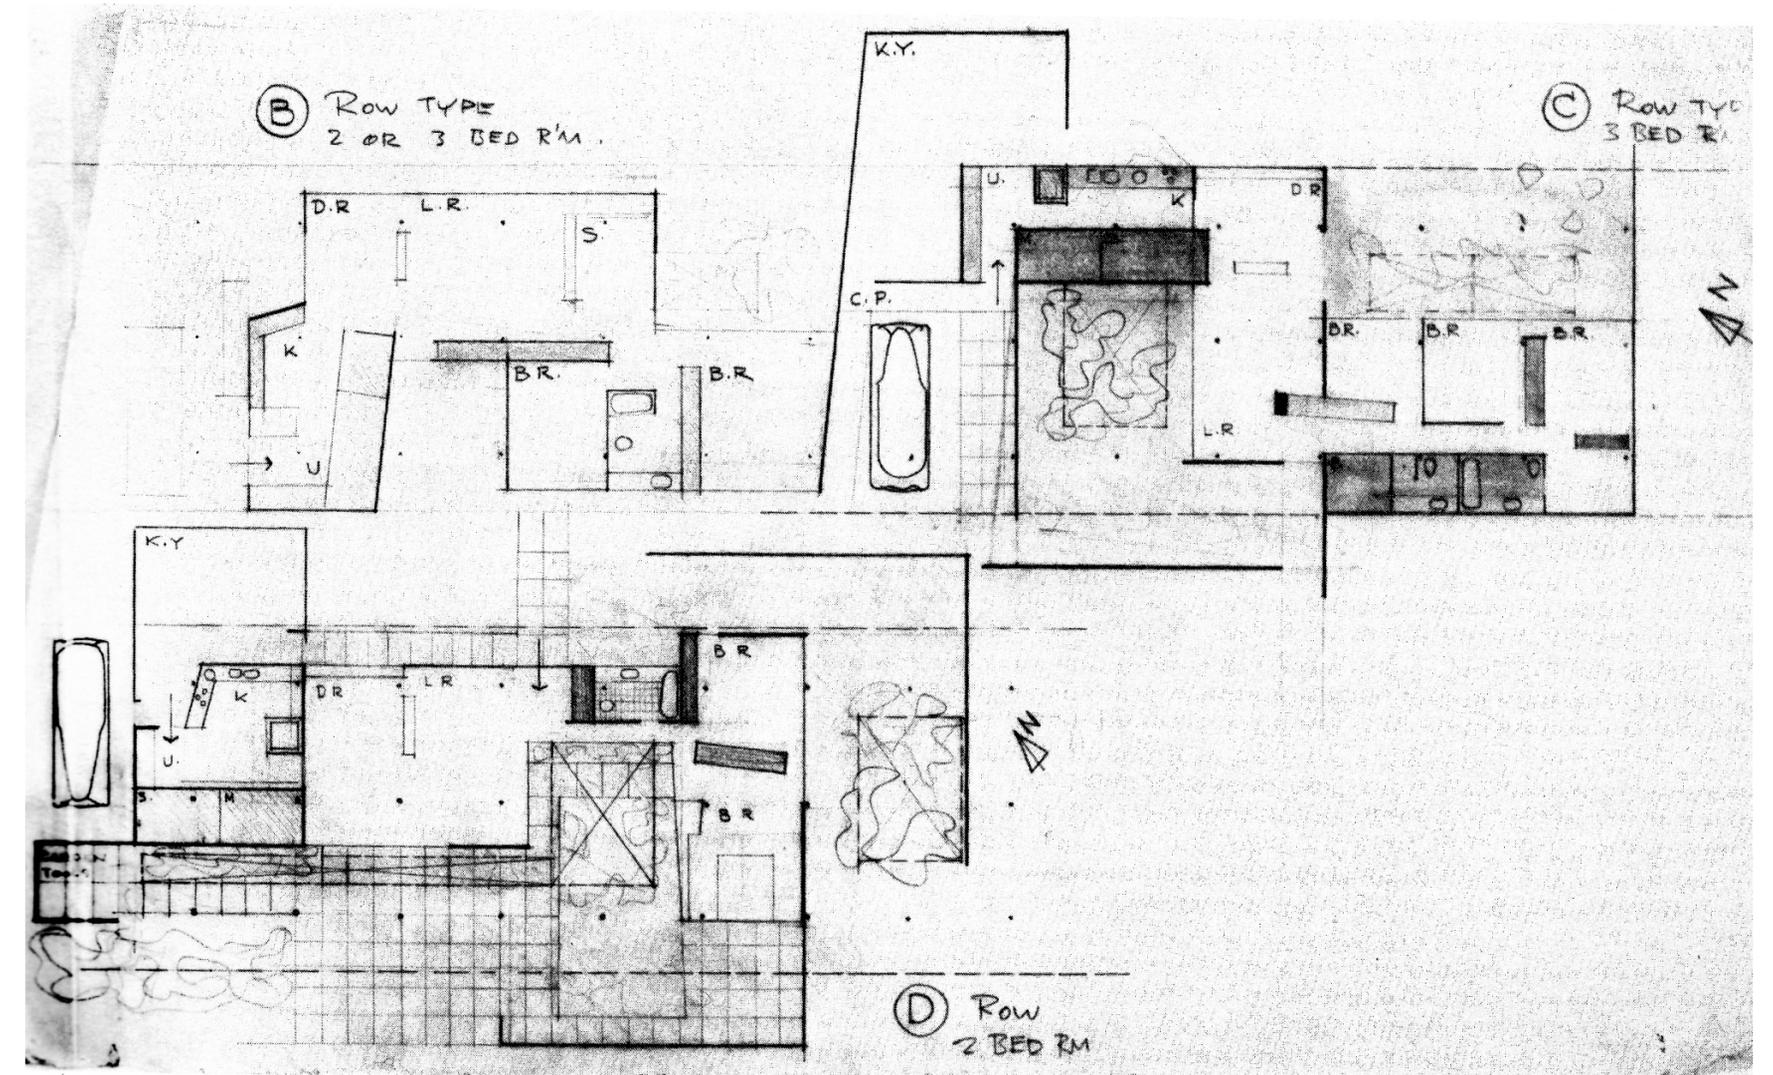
Kahn y Stonorov. Plantas viviendas tipo B, C y D. 1944.
